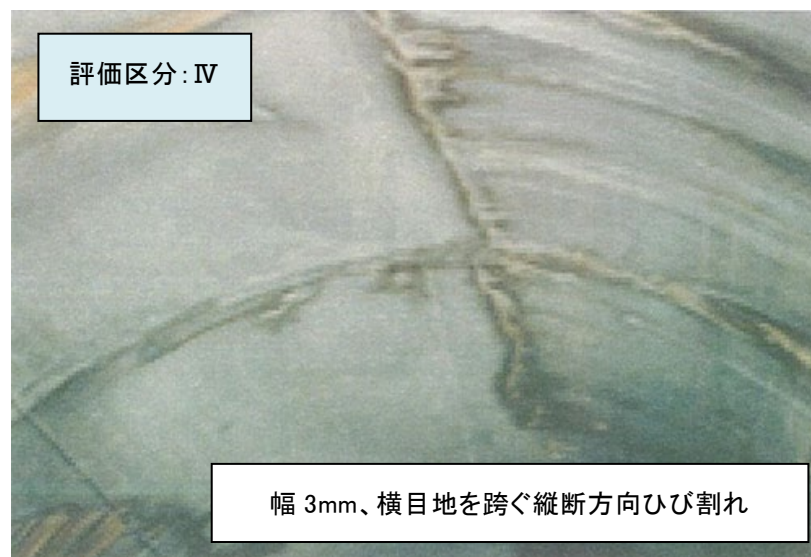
損傷例(覆工:ひび割れ:進行性あり)
